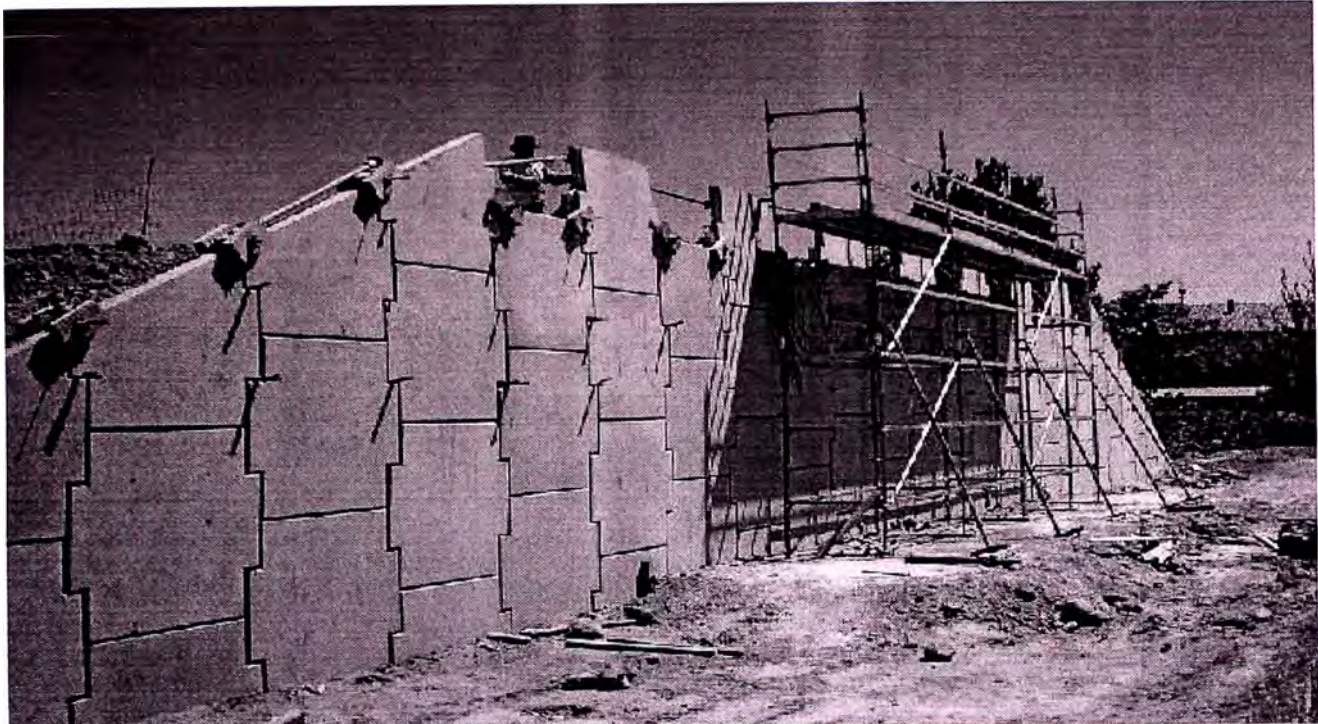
Muro reforzado con cobertura de enchape de concreto.
